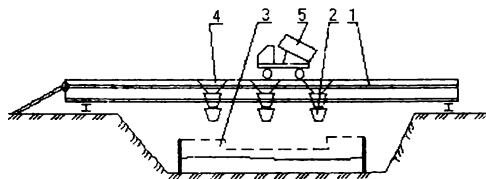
Схема укладки бетонной смеси с передвижного моста.
